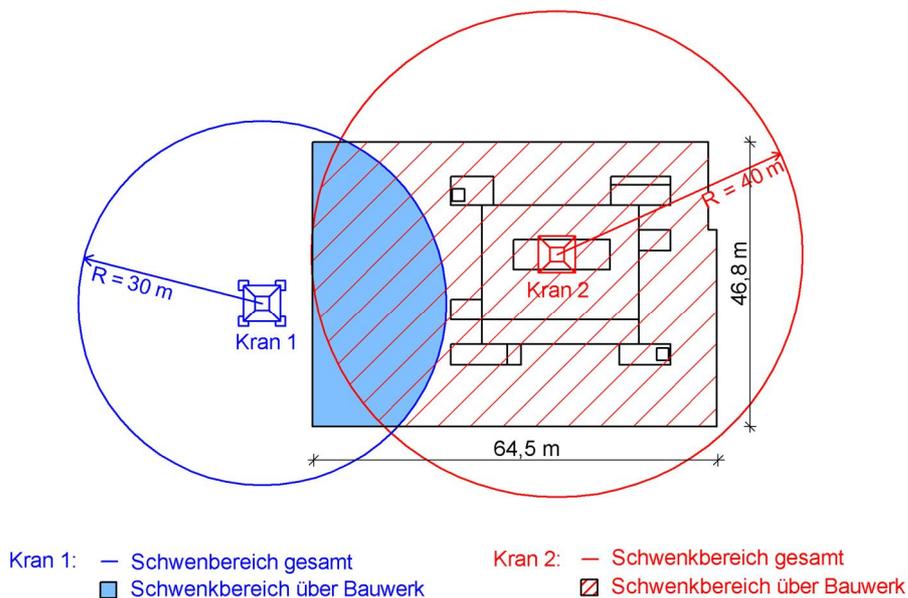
Schwenkbereich von einem innen- und außen platzierten stationären Kran zur Ermittlung der Krananzahl über die Grundrissfläche
